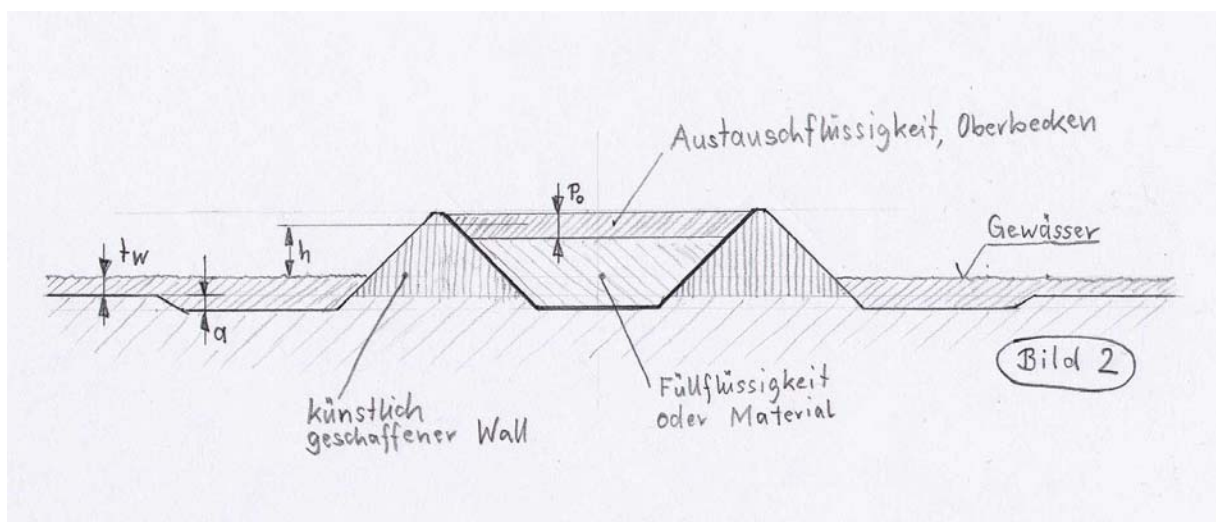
„Kegelringspeicher“ mit abgesenktem Innenbecken in einem Gewässer (z.B. Meer oder See)
